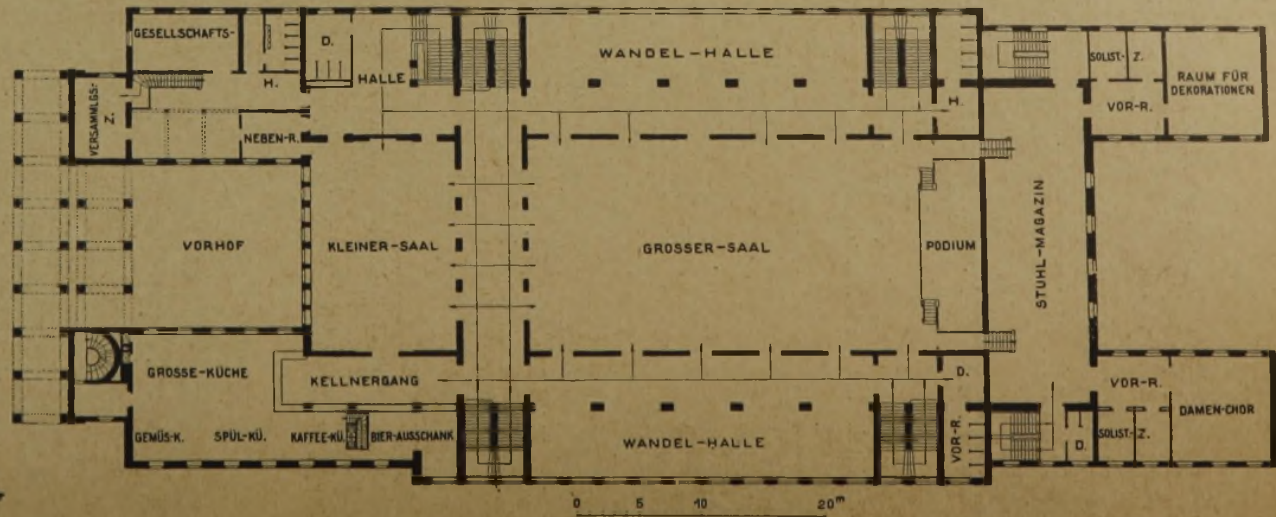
Grundriß des Saalgeschosses. (1 : 600.)
